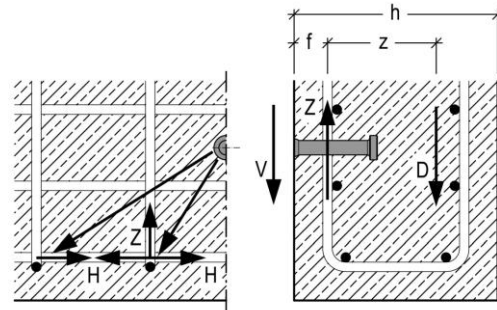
Fachwerkmodell bei Querbelastung zum Bauteilrand nach Schmid (2009)
